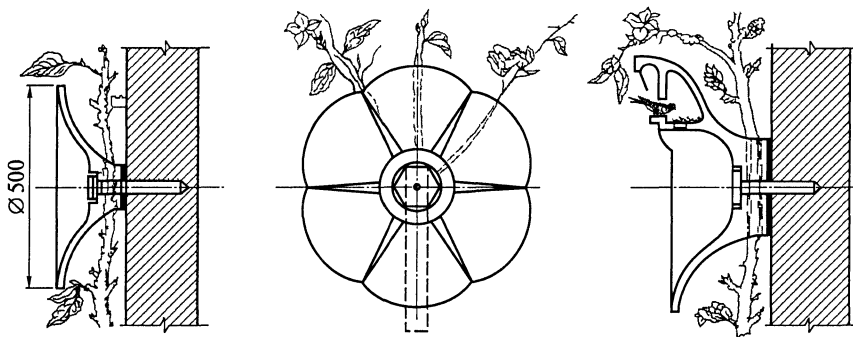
Виды кронштейнов («розеток»), используемых для крепления растений и украшения фасадов, стен
